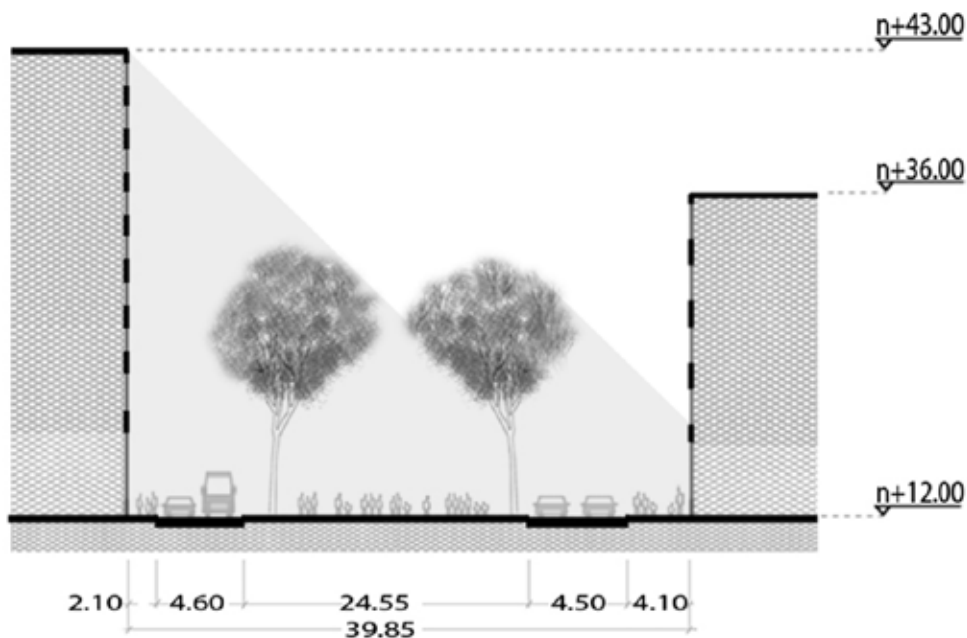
Sección vial de la Rambla. Elaborado por el autor.
